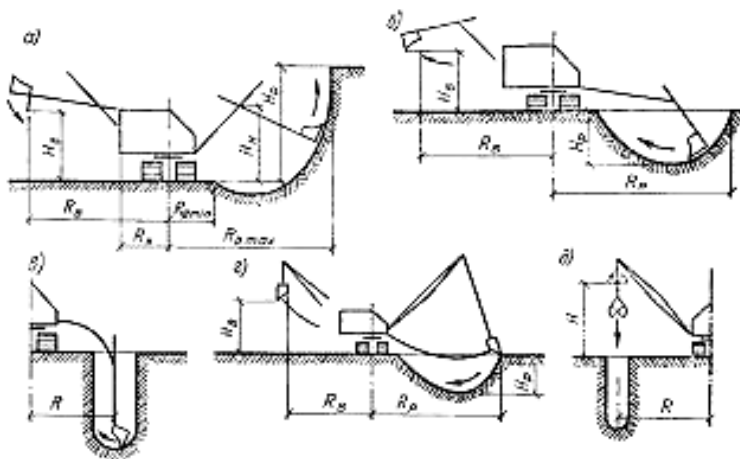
Схемы рабочих параметров одноковшового экскаватора: а — прямой лопаты; б — обратной лопаты; в — обратной лопаты с поворотным ковшом; г — драглайна, д — грейфера.
